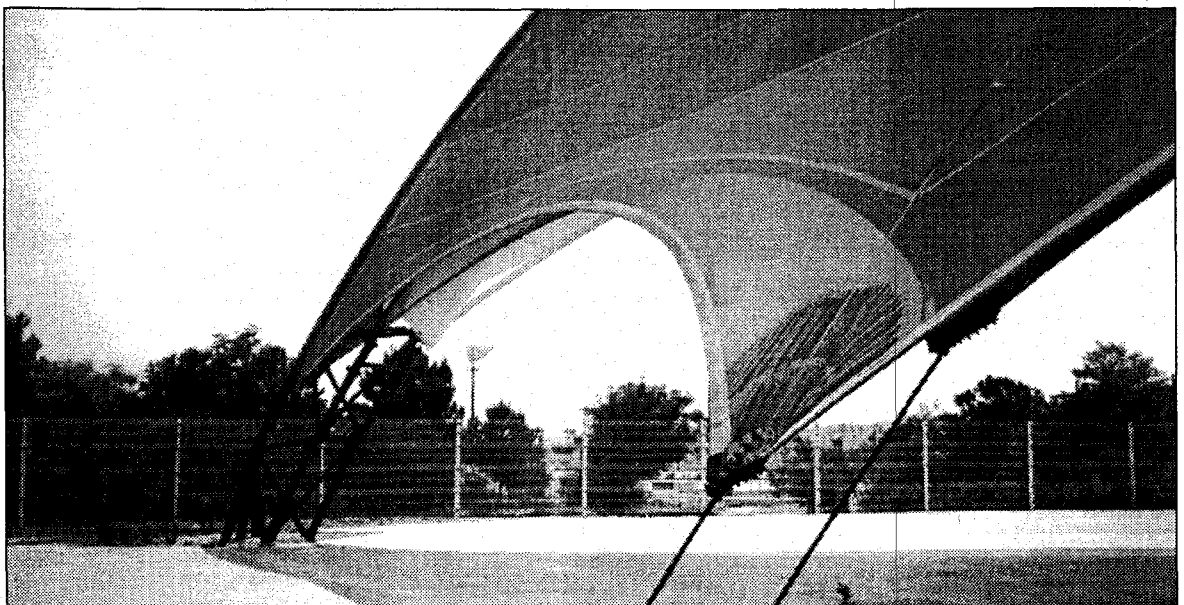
Detalle de la cubierta. Apeadero del AVE .
